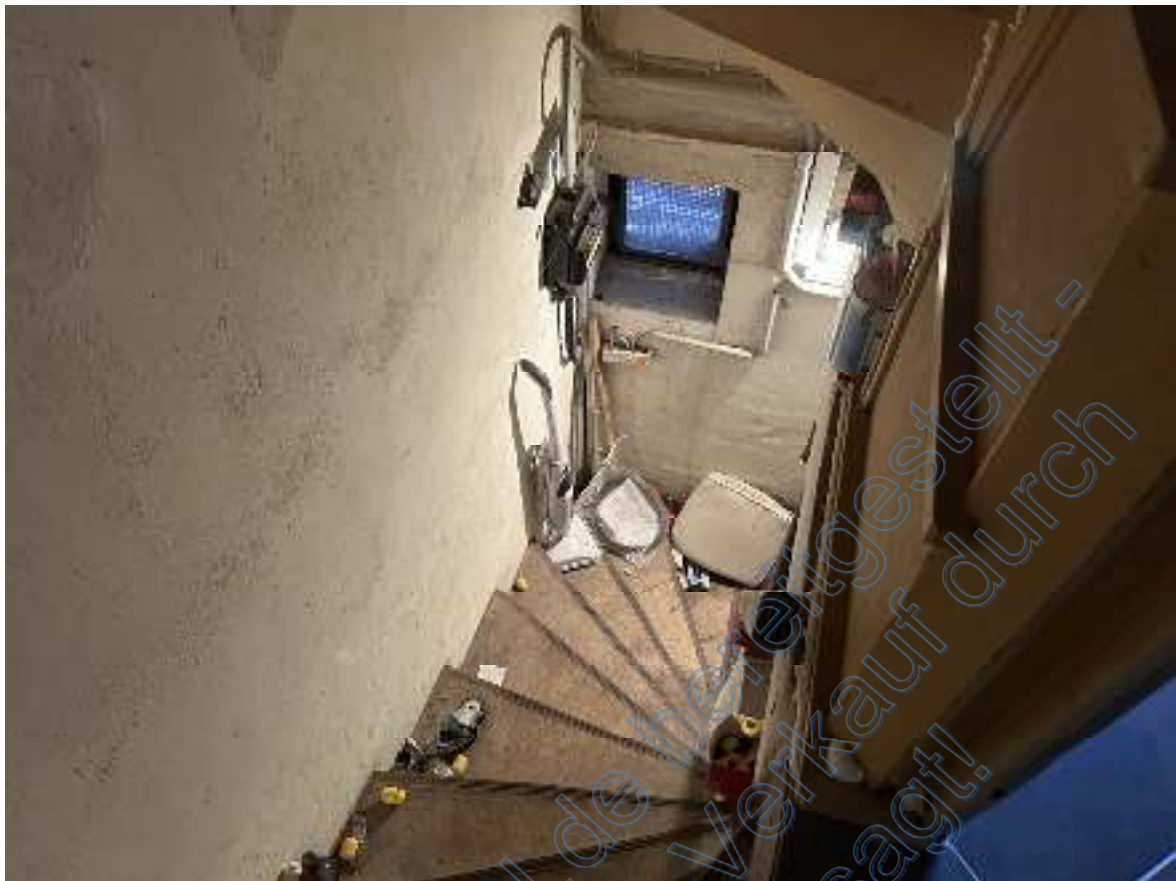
Ausschnitt – Treppe Richtung Flur im Kellergeschoss
